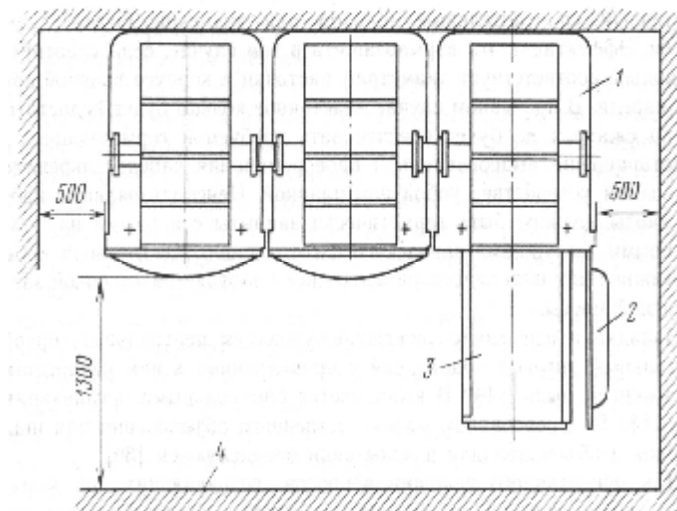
Габаритные размеры и общий вид КРУВ-6
